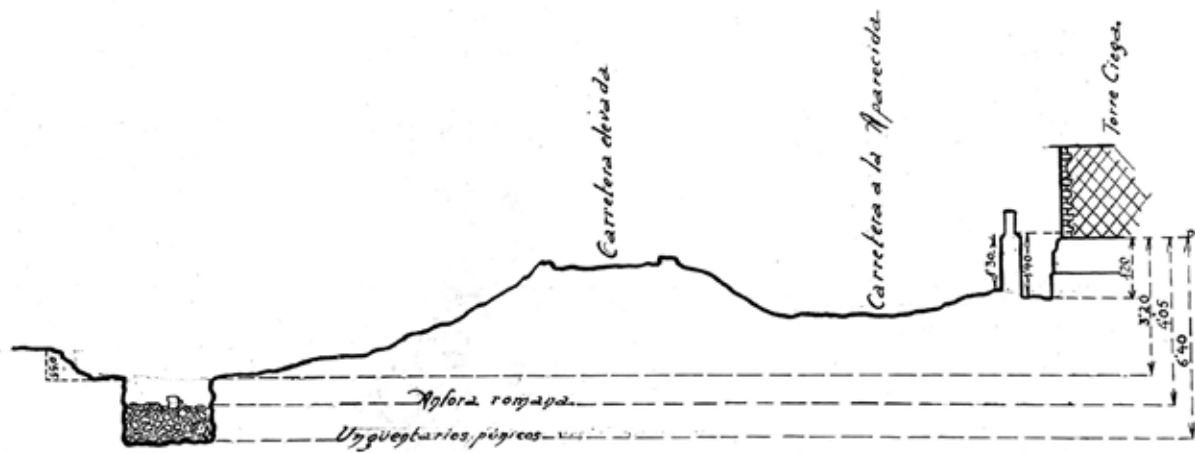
Dibujo en sección de la sepultura excavada por P. San Martín en 1957 junto al tramo septentrional del tramo elevado de la carretera Cartagena –San Javier.
